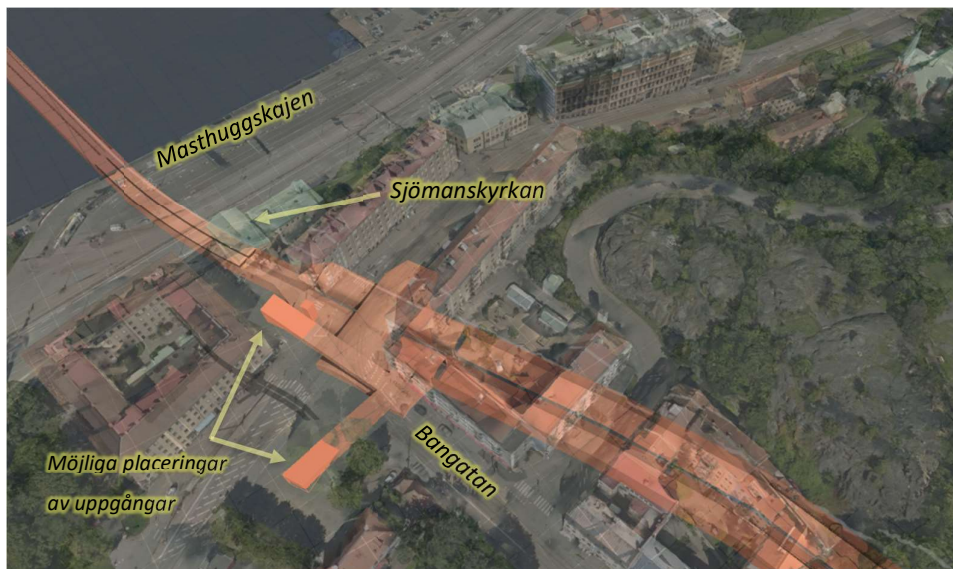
Alternativ Tunnel. Översikt som visar tänkt läge för tunnelpåslag på Stigberget¹⁷. Den slutliga utformningen är inte fastlagd.
